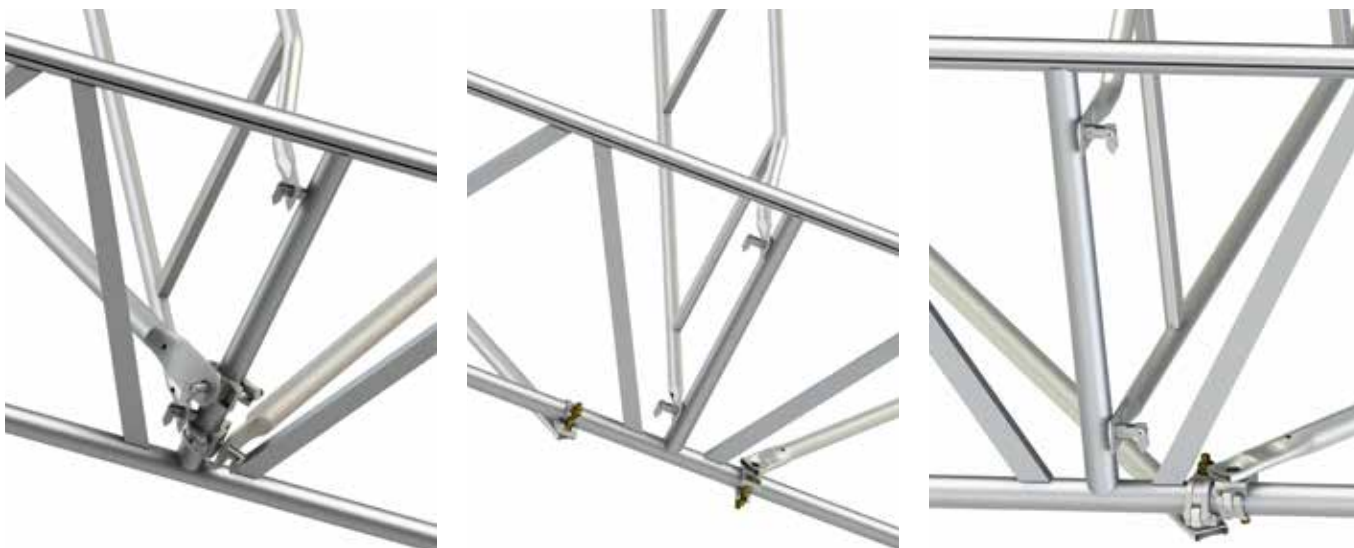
Montaż poręczy w pierwszym polu bazowym połaci dachu.
